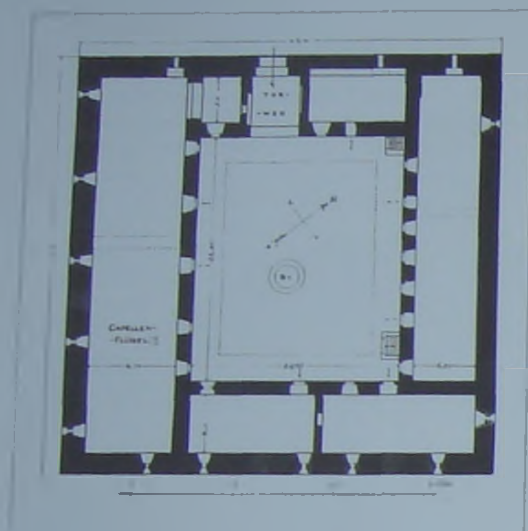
Insterburg. Grundriss der Deutschordensburg (nach Steinbrecht)
